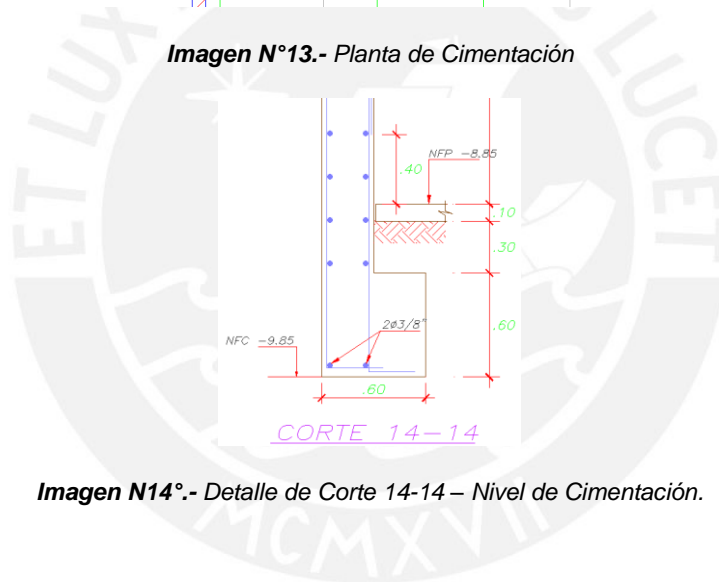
°.- Detalle de Corte 14-14 – Nivel de Cimentación.
